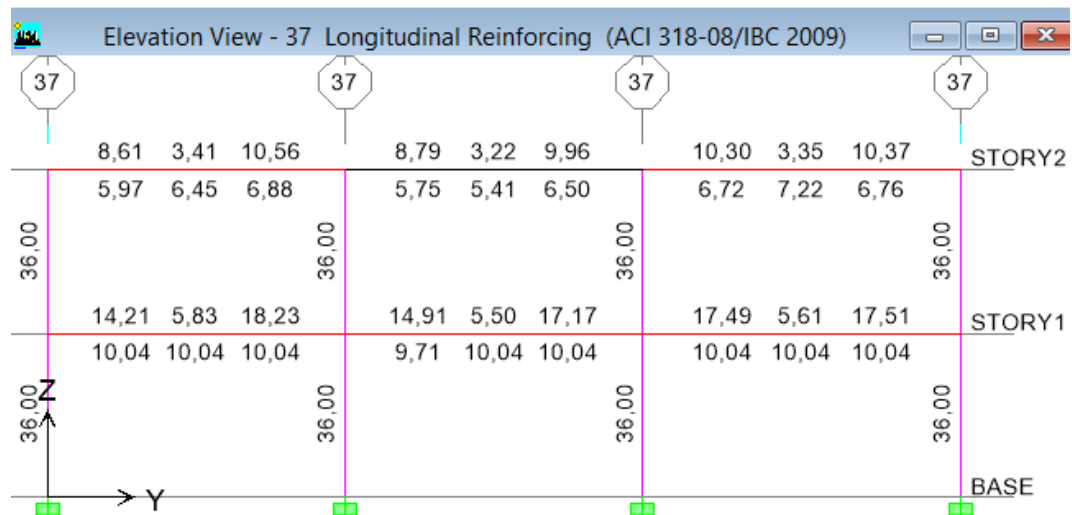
Acero en Vigas y Columnas en el Pórtico 37 – C. Quirúrgico- (CEC2002)
